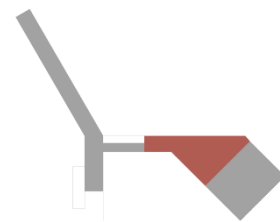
Planta Esquemática do piso térreo da Biblioteca
